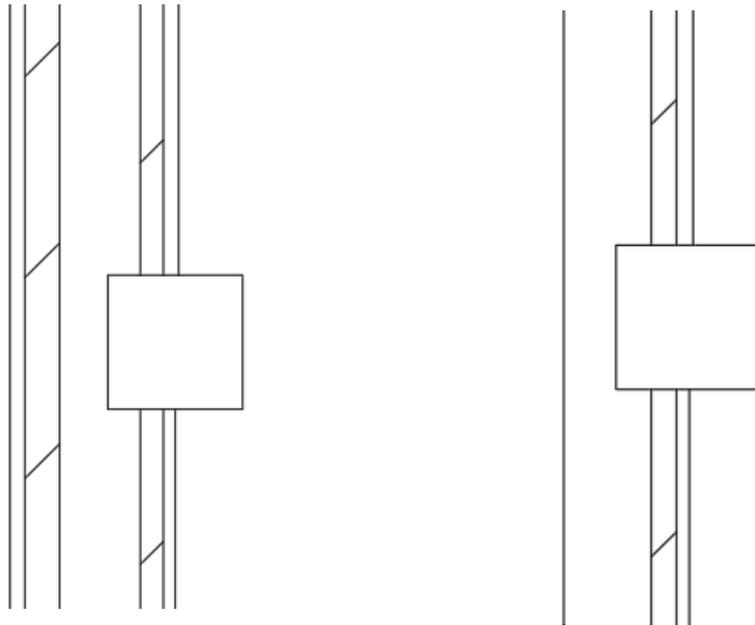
comparación de pilar aislado con SATE y pilar rompiendo aislamiento
